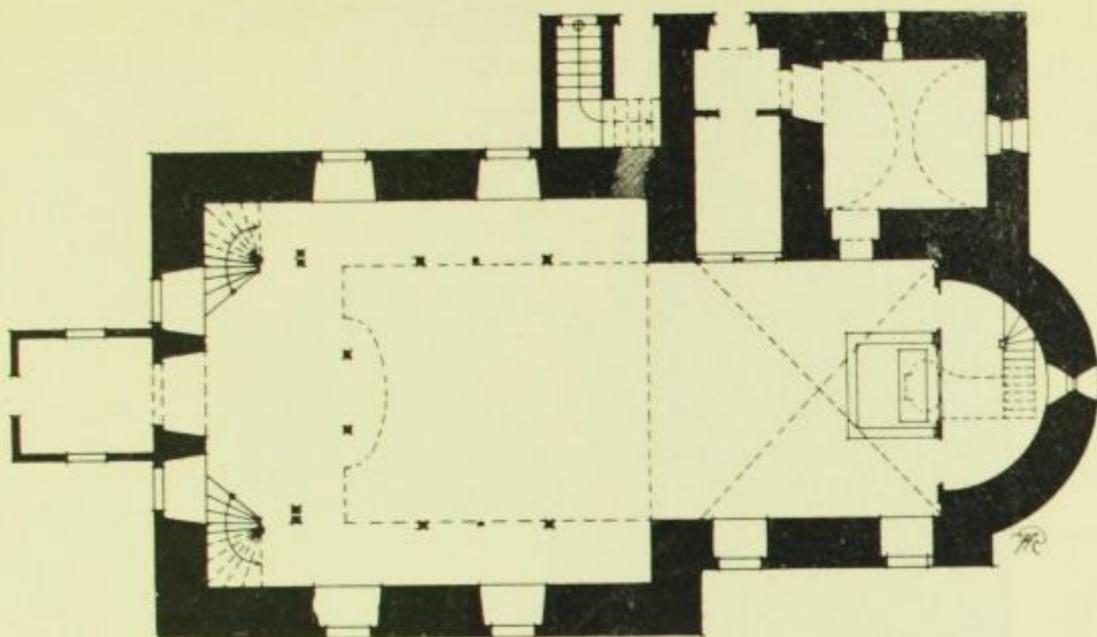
Ruppertsdorf, Kirche, Grundriß.
